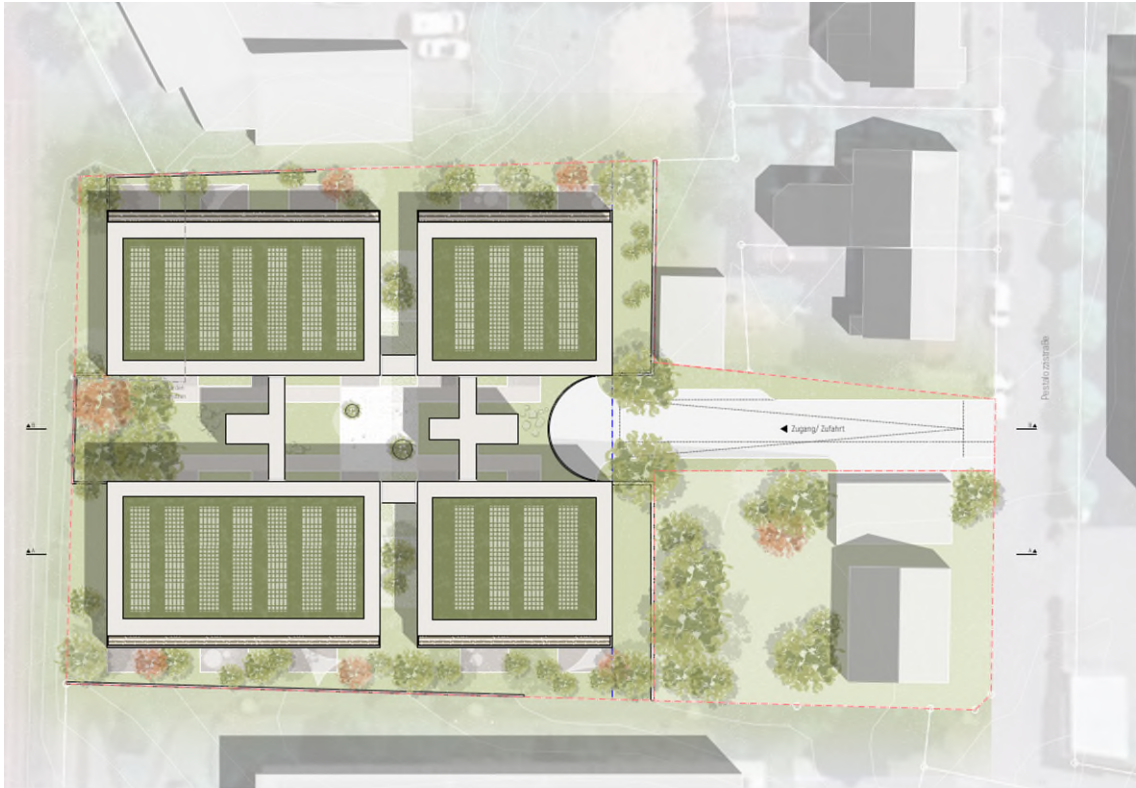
Bauvorhaben Pestalozzistraße, Architekturbüro Müller+Partner, Oberkirch, Oktober 2025
